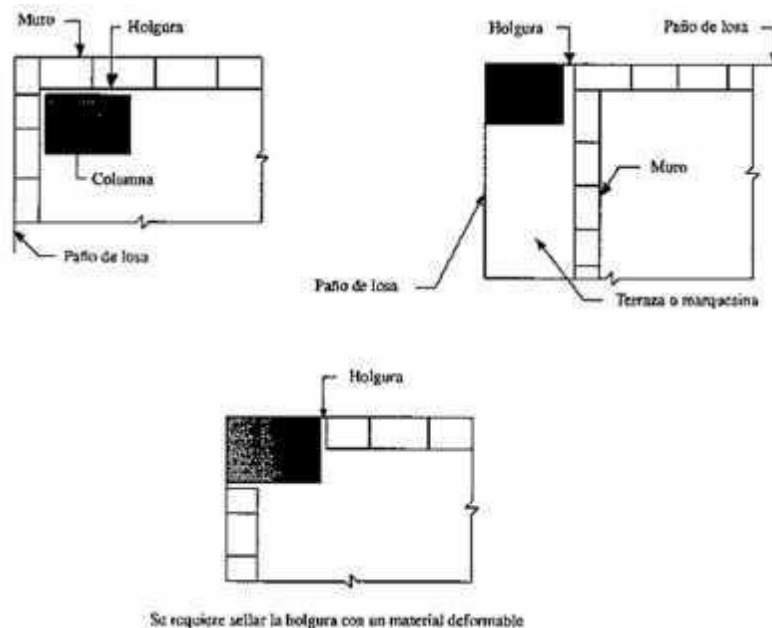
Detalle de muro, con holgura (vista en planta), (Bázan y Meli, 2004).
